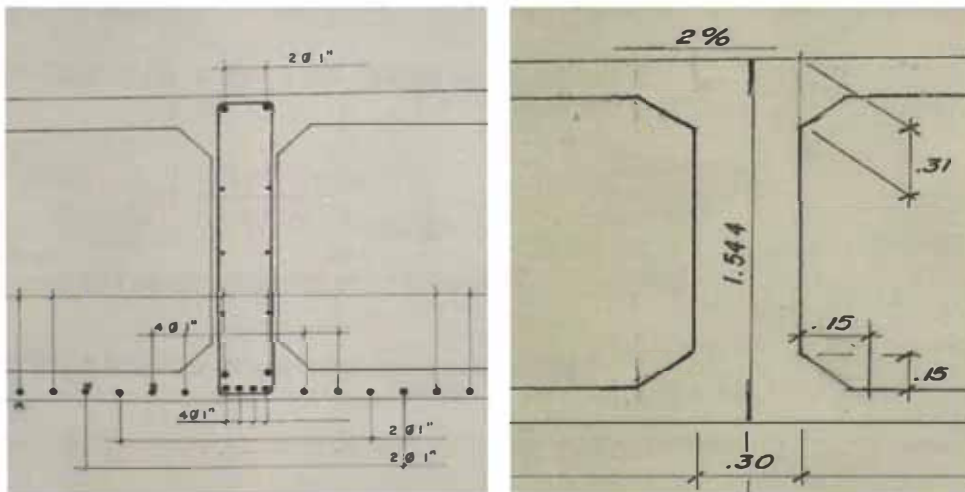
Vista de la sección de viga interior con refuerzo para el momento positivo.
